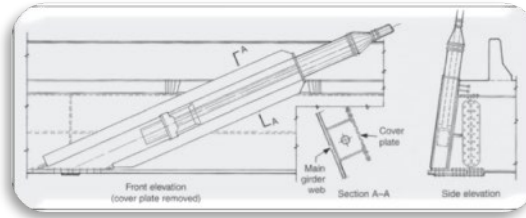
Anclaje con conexión lateral a la viga de acero, puente Baytown. Fuente: [25]
